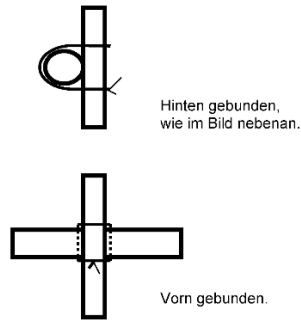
„Schlaufe“ bei horizontal belasteten Stäben an vertikal stehenden Stäben im Geflecht
